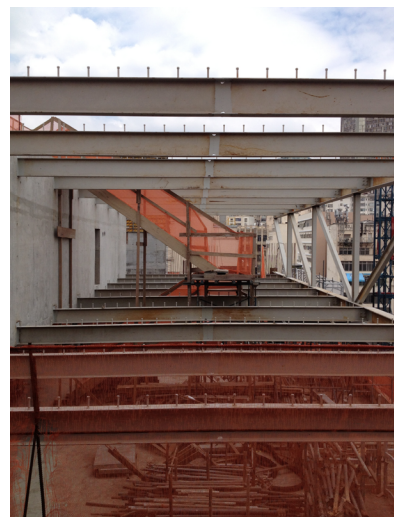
Estructura metálica del bloque de los vestuarios. (Fuente: MMBB Arquitectos).
